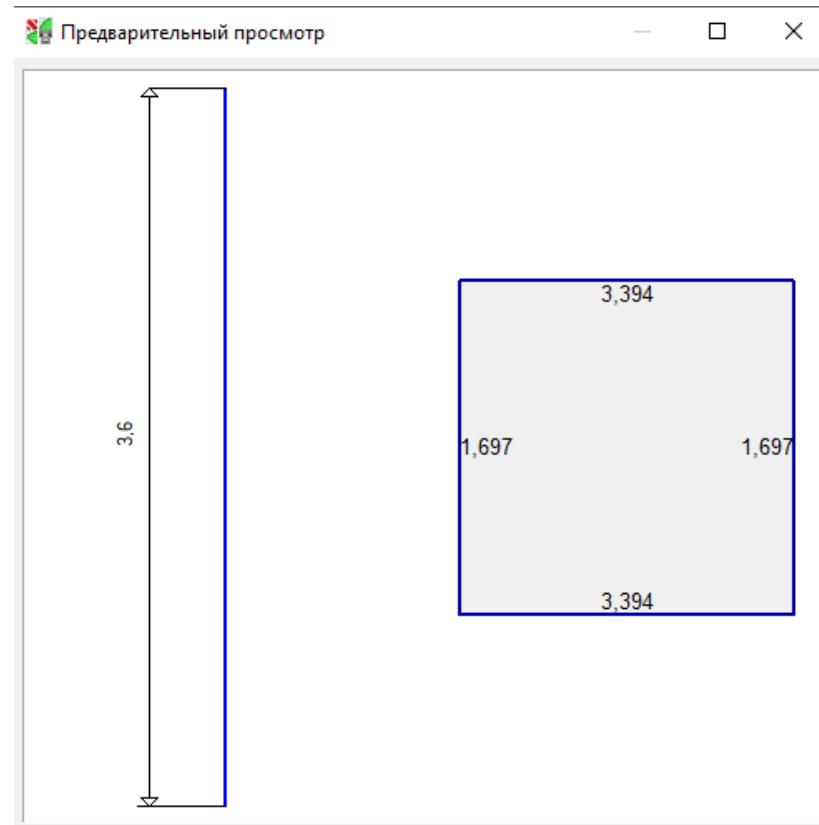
Результаты вычисления площади арматуры в колонне 2-го этажа
